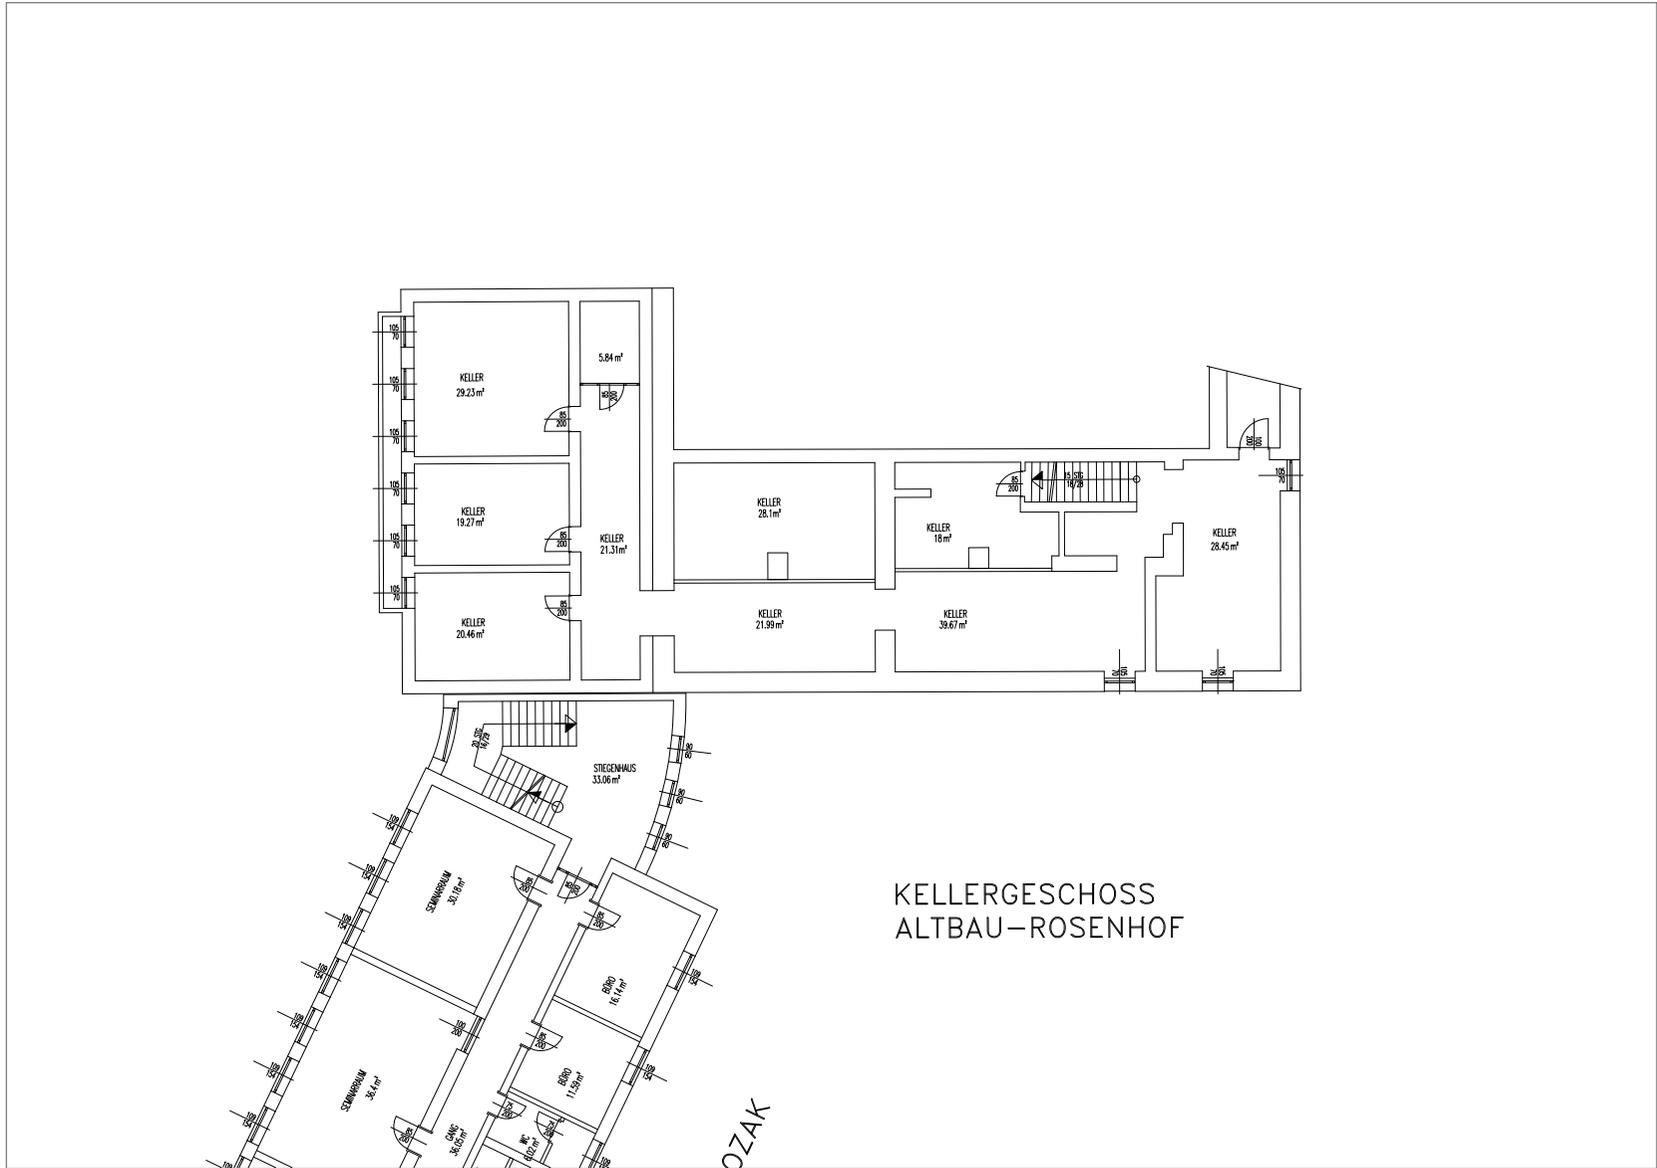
Grundriss des Kellers des Altbaus, ehemaliges LJH Rosenhof (Hartsleben 1999)
